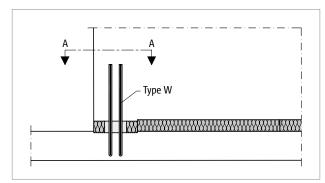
Schöck Sconnex® type W-N-VH : renforcement sur site pour le raccordement en l'extrémité du mur
